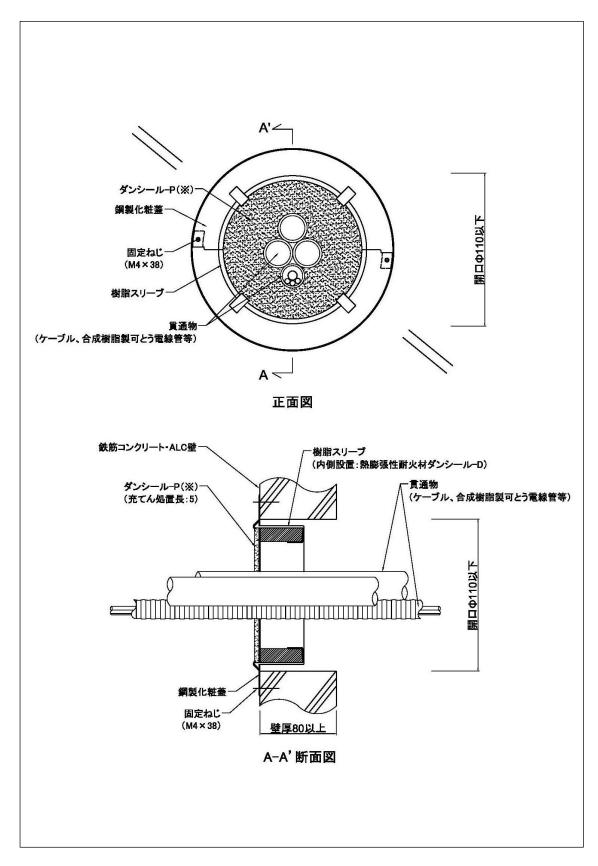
プチロクワイド 標準施工図(鉄筋コンクリート・ALC 壁 片側施工)
